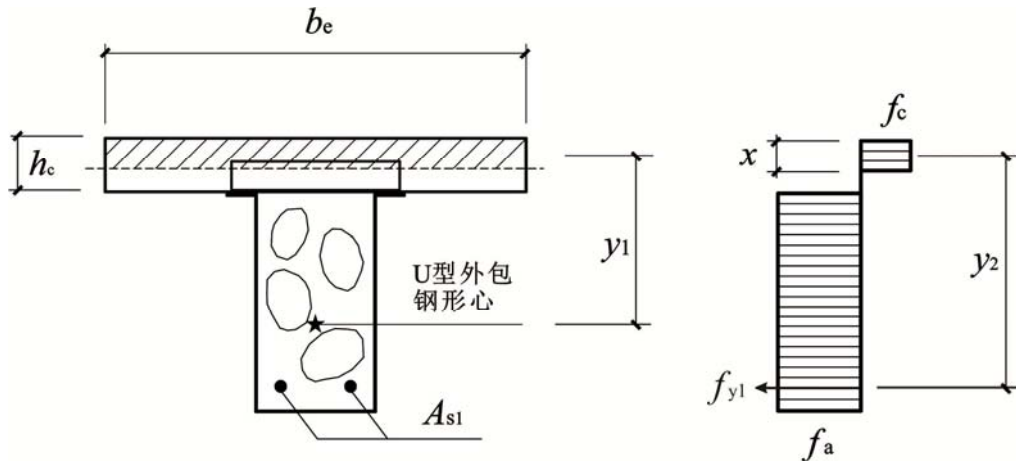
塑性中和轴在钢筋混凝土翼板内的梁截面应力分布
